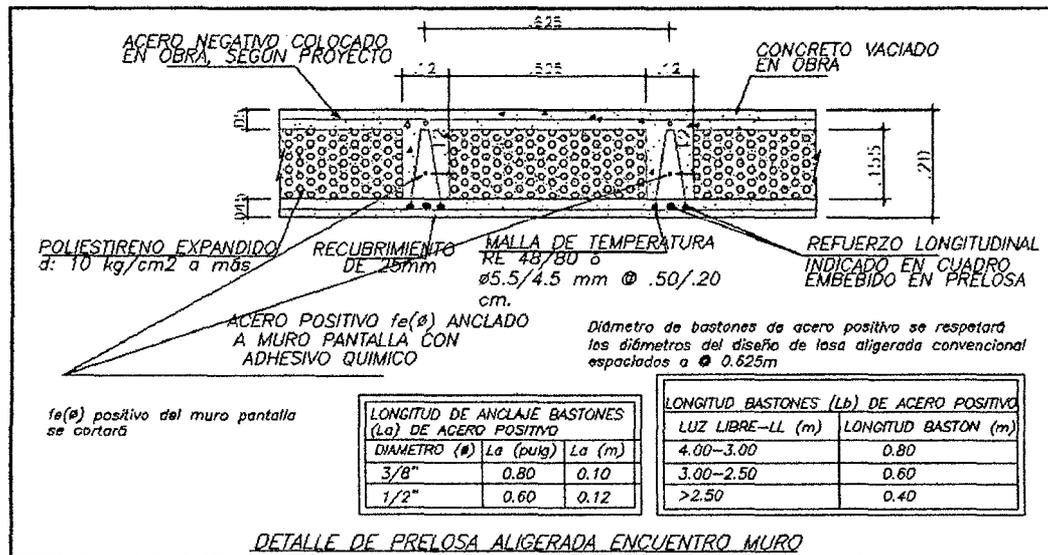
25: Acero de prelosa aligerada y encuentro con Muro pantalla
